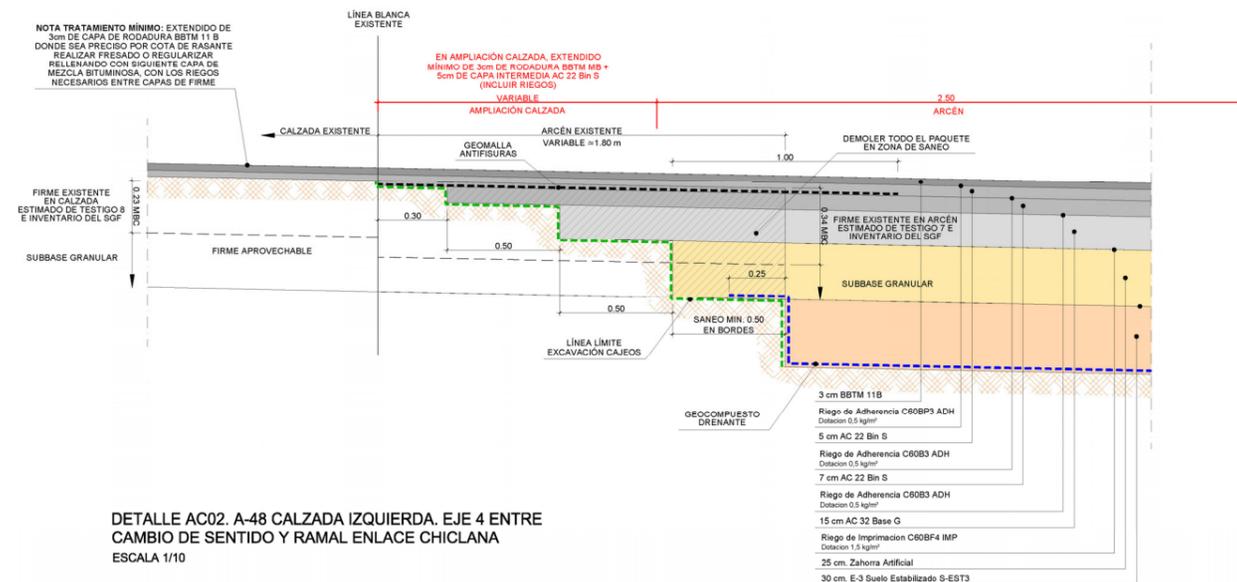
Detalle de ampliación de calzada extraído del documento nº 2. Planos
